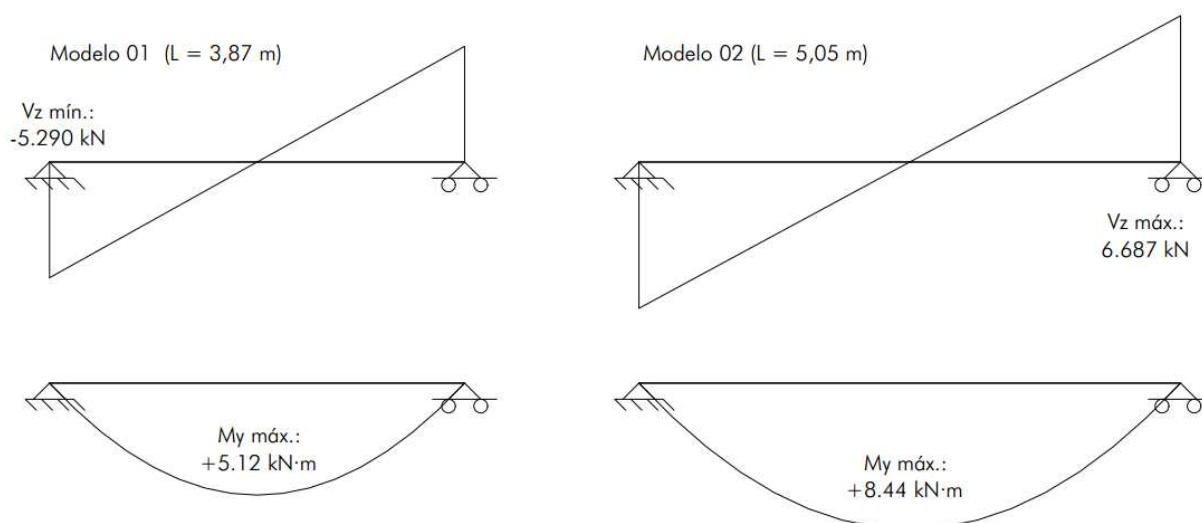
Envolventes de cortantes y flectores de los modelos 01 y 02 de la planta de cámaras
